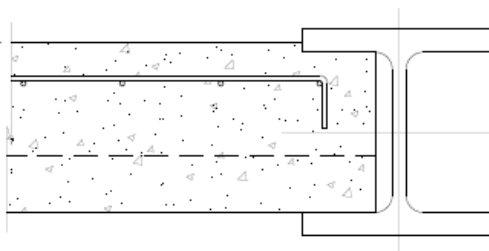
Detalle de apoyo del forjado colaborante con el perfil perimetral HEM. Fuente: (Europerfil 2014).
